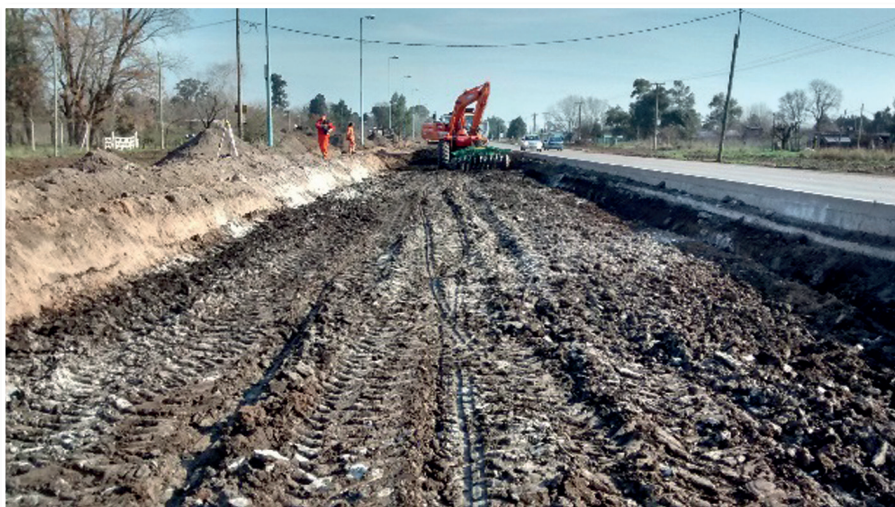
"Secado" del suelo húmedo (sub-rasante pavimento de hormigón).
